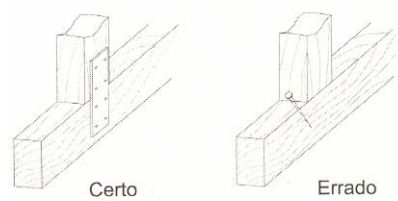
Exemplo de ligações de ligações correcta e errada entre secções de madeira
